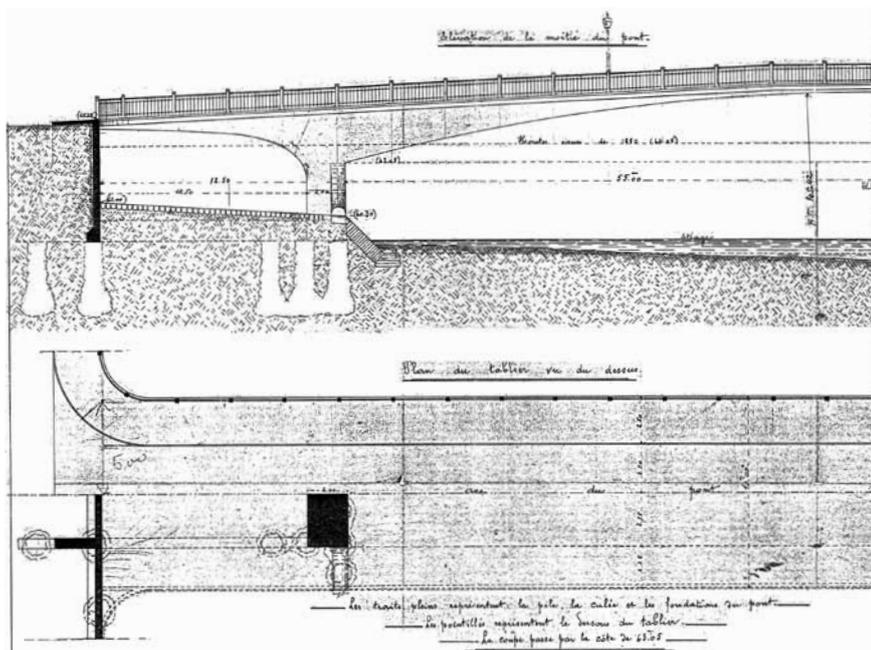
Élévation, plan et coupe de la passerelle Mativa²
